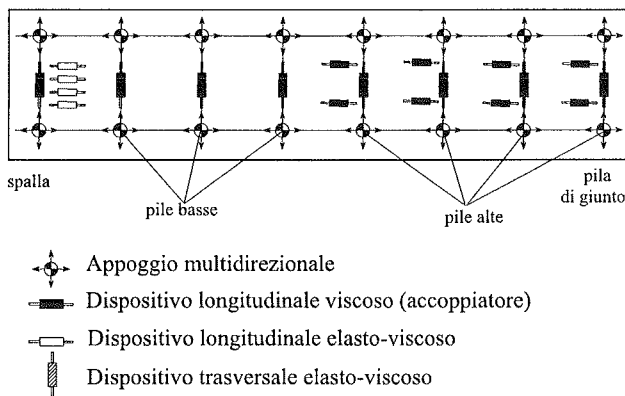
Schema planimetrico dei vincoli nel progetto di adeguamento per viadotti con pile alte
